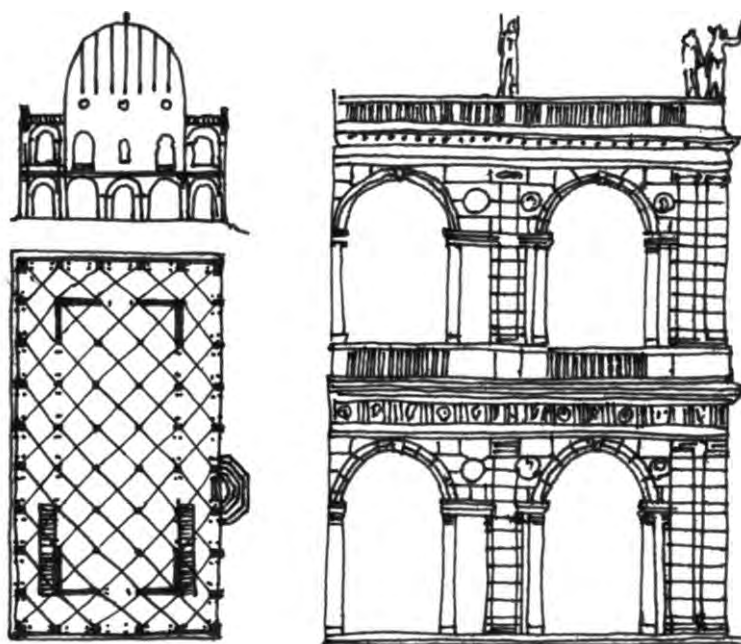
Базилика. План, разрез, фрагмент фасада
